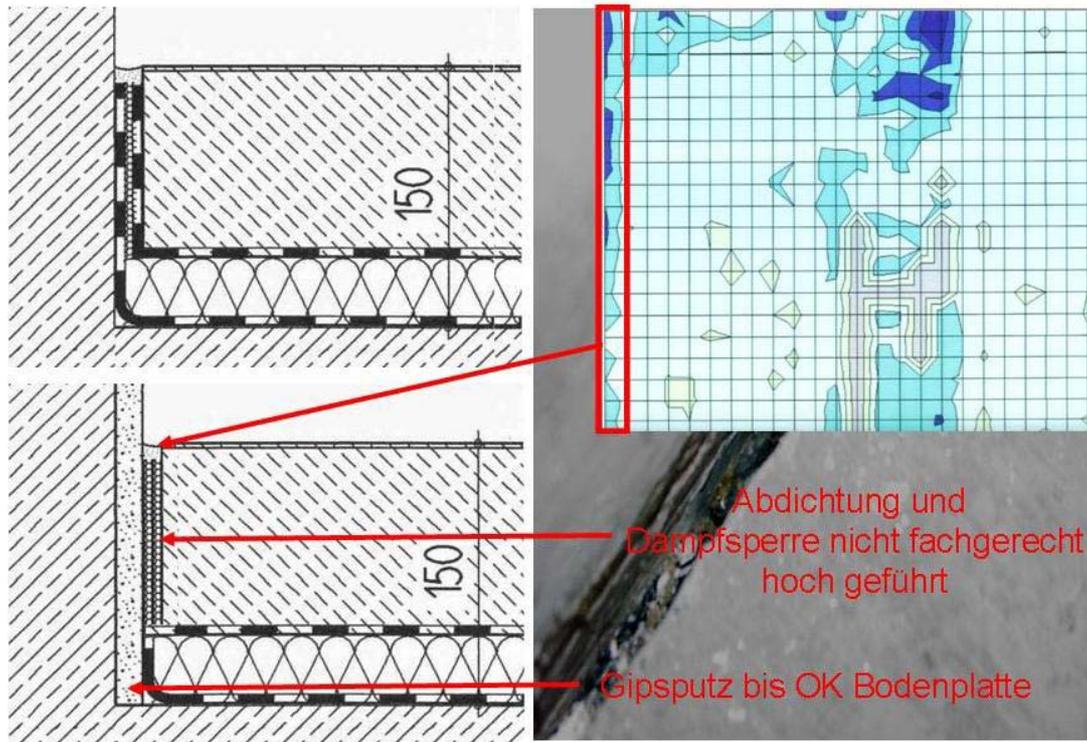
Exemplarische Gegenüberstellung eines fachgerecht (oben) und nicht fachgerecht (unten) ausgeführten Bodenaufbaus mit Darstellung eines möglichen Schadensbildes
